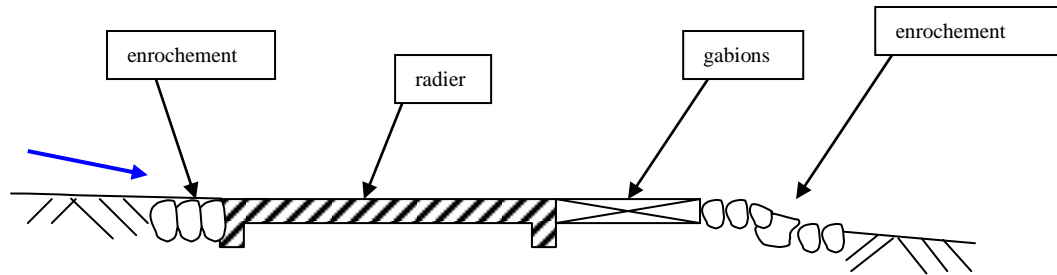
Coupe d'un radier en zone de faible affouillement
